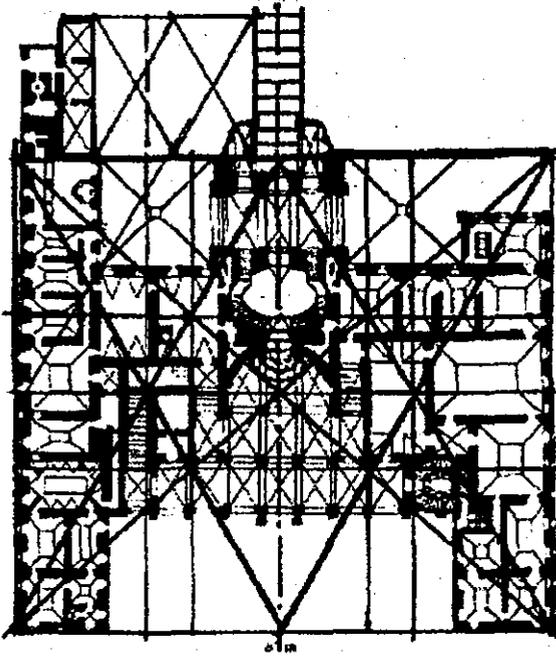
Trazo general de la planta del Palacio Barberini proyectado por Maderna.
